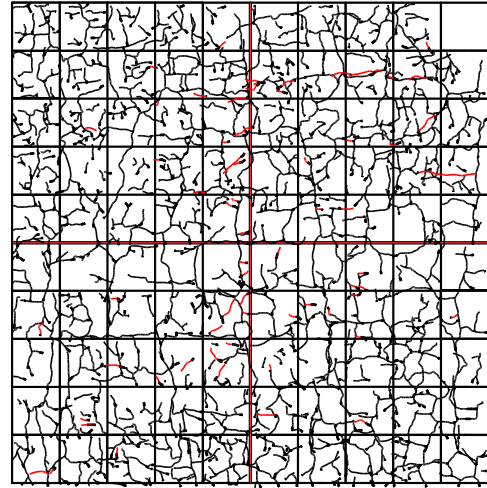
4. 7 に、載荷試験後の供試体下面のひび割れ状況を示す。なお、図中の赤線は各段階において新規に生じたひび割れを表す。載荷試験前から、供試体下面には ASR によるひび割れが格子状に生じていた。載荷による曲げひび割れは明確には認められず。ASR により生じていたひび割れ間を連結するように、新たなひび割れが生じた。載荷による新たなひび割れの本数は少なく、床版下面のひび割れの進展状況は、部分打替えを行っていない ASR 劣化供試体と同様の傾向を示した。
